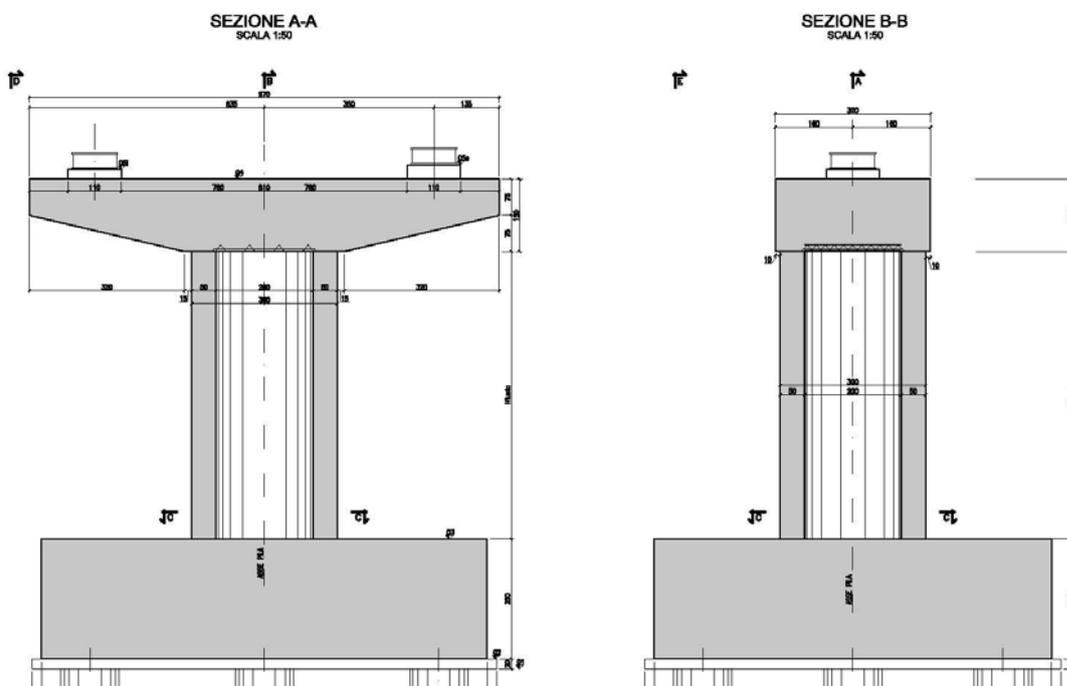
Prospetti (frontale e laterale) della pila tipo.
